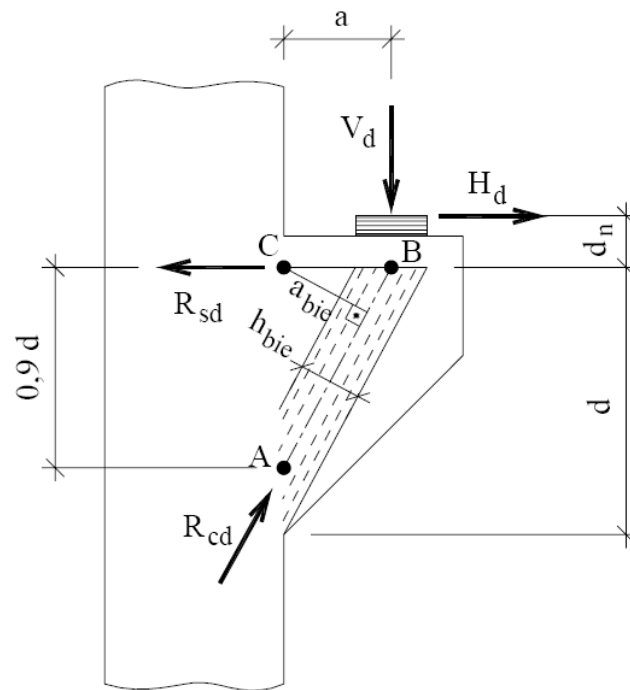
Modelo de bielas e tirantes para análise de consolos curtos - Leonhardt e Mönning [3] adaptado por El Debs [1].
